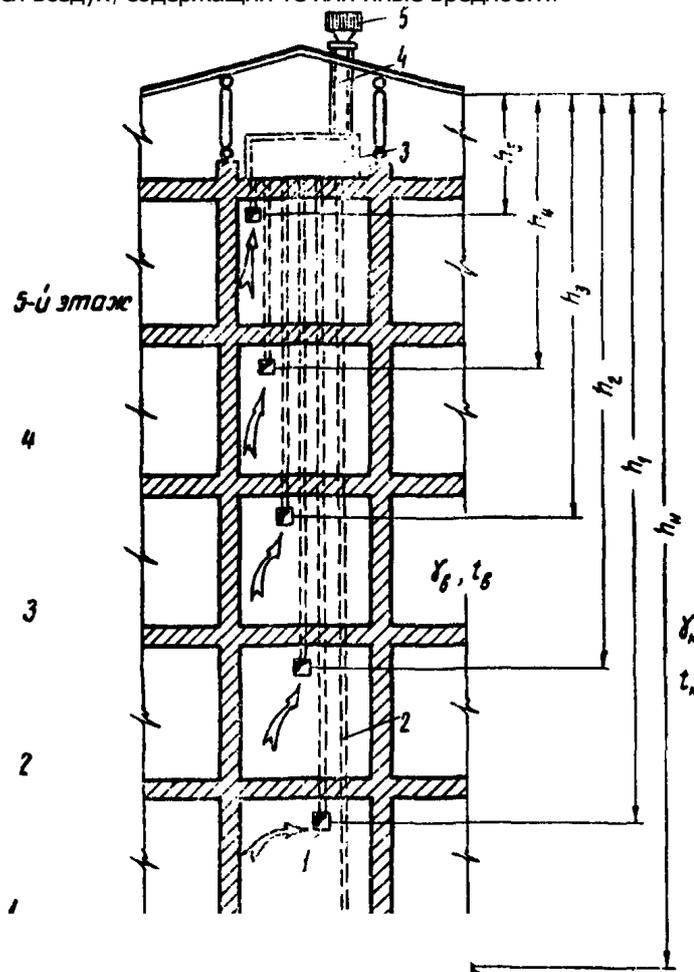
Схема естественной вентиляции помещений 5-этажного дома под действием теплового напора:
